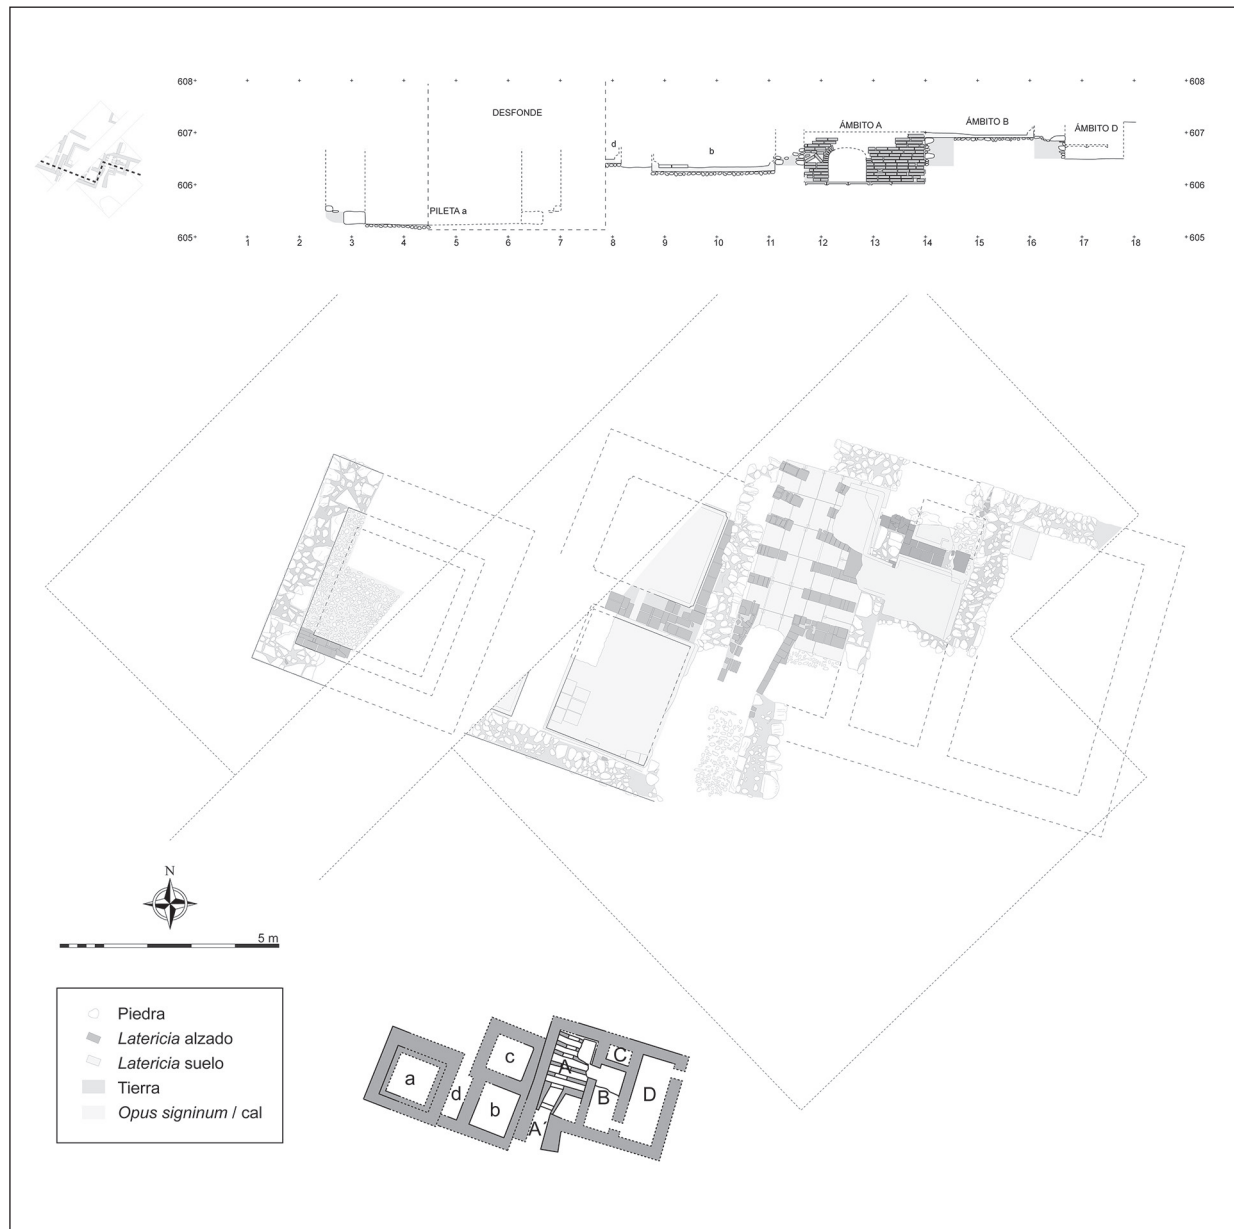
Planimetría y sección de la primera fase en las áreas A y B.
